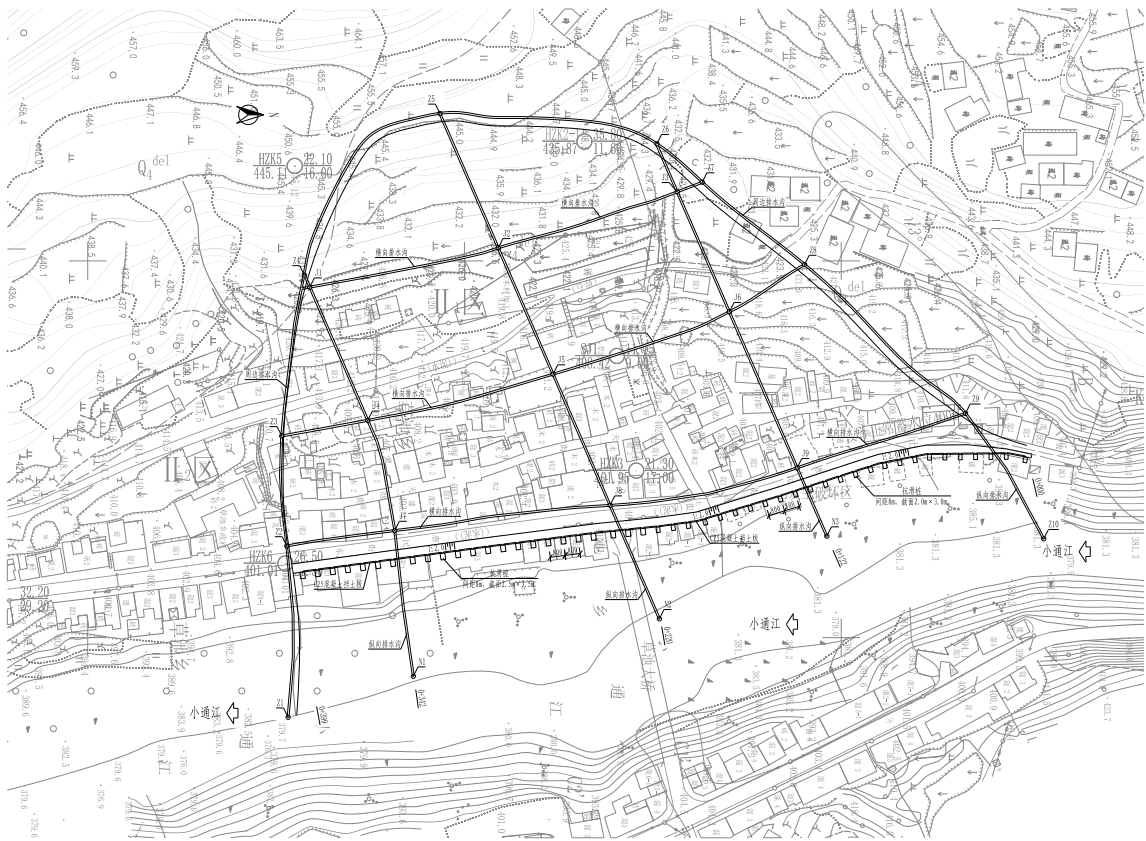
滑坡治理平面布置图（抗滑桩支挡方案）
